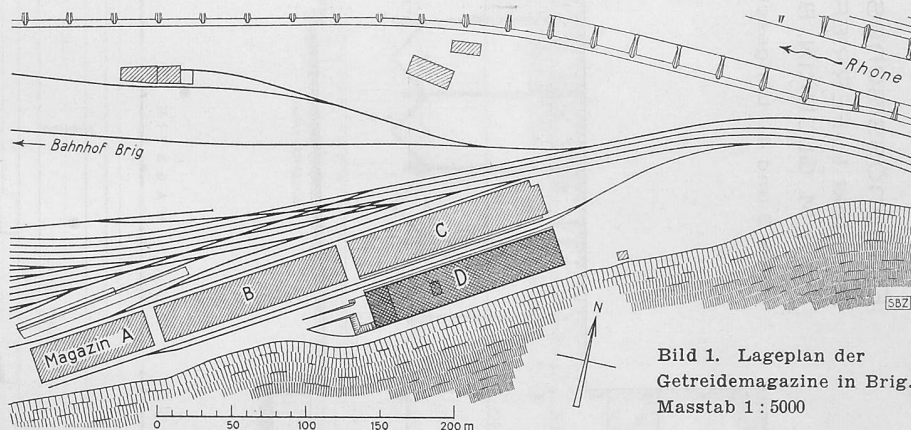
Lageplan der Getreidemagazine in Brig. Masstab 1 : 5000
